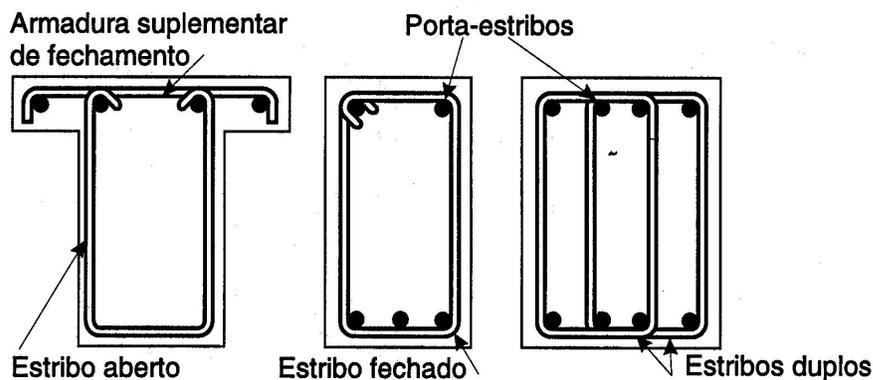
Arranjos básicos de estribos de vigas. Fonte: FUSCO (1995)
